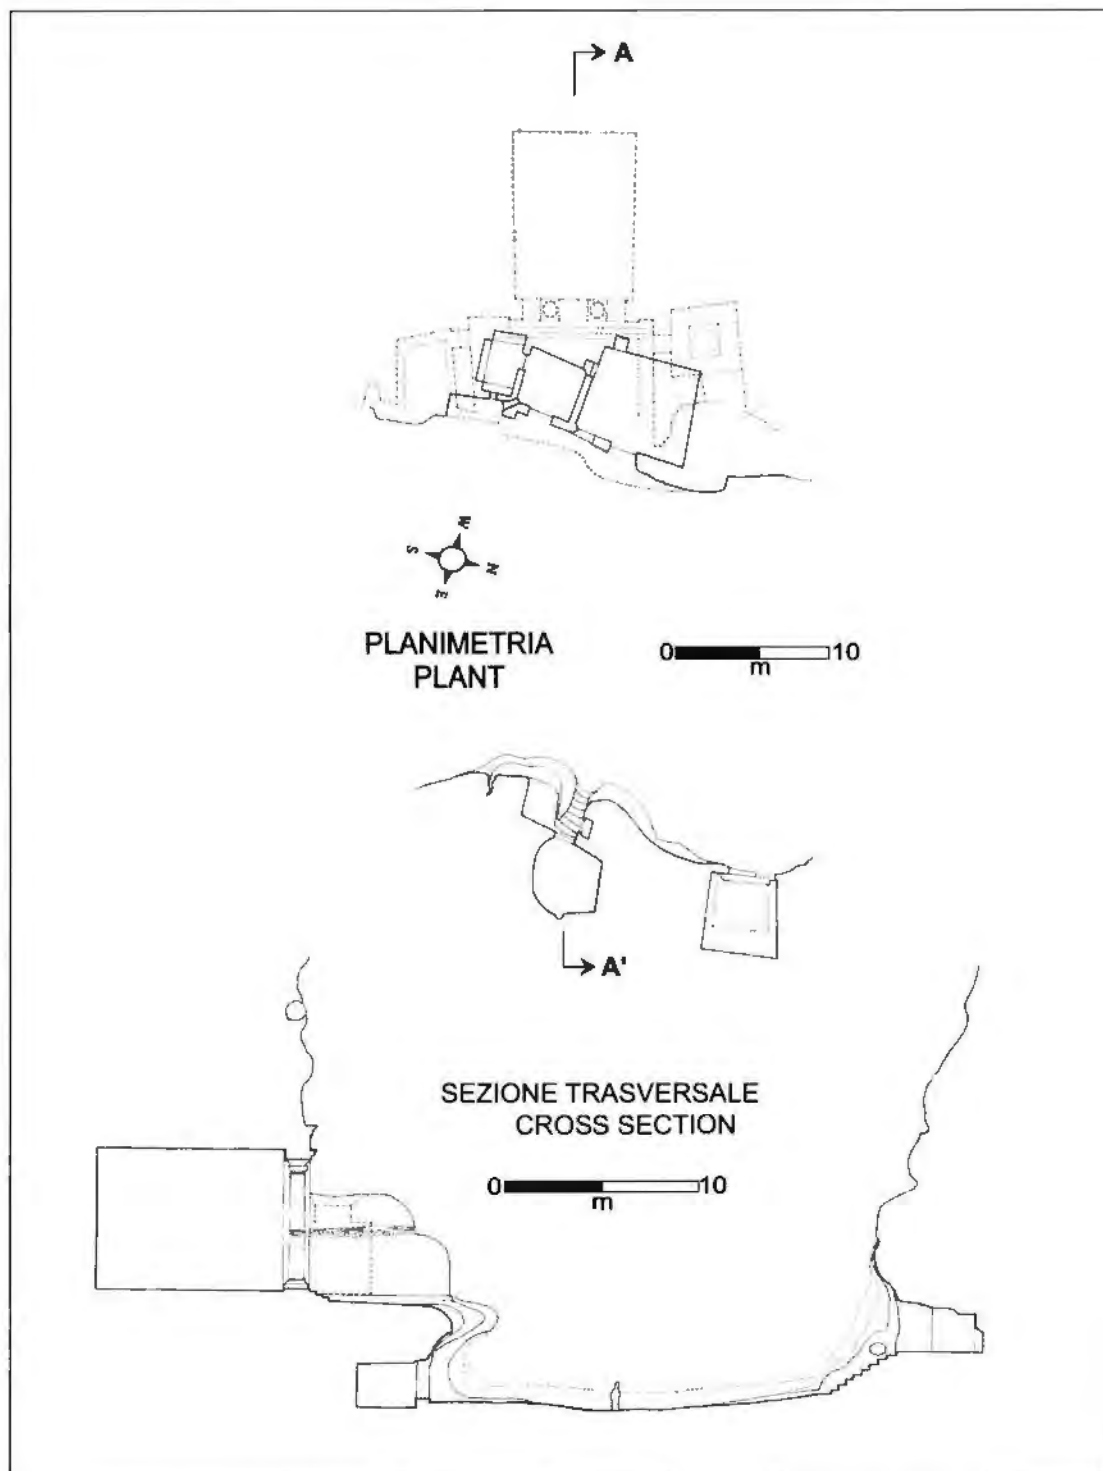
pianta e sezione del tempio che si incontra dopo lo stretto passaggio di accesso al siq (cfr. anche fig. 4 - grafica degli Autori).
